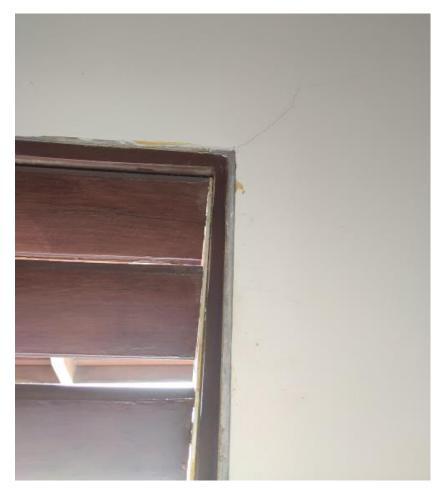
Fissura na parede interna do quarto do casal
